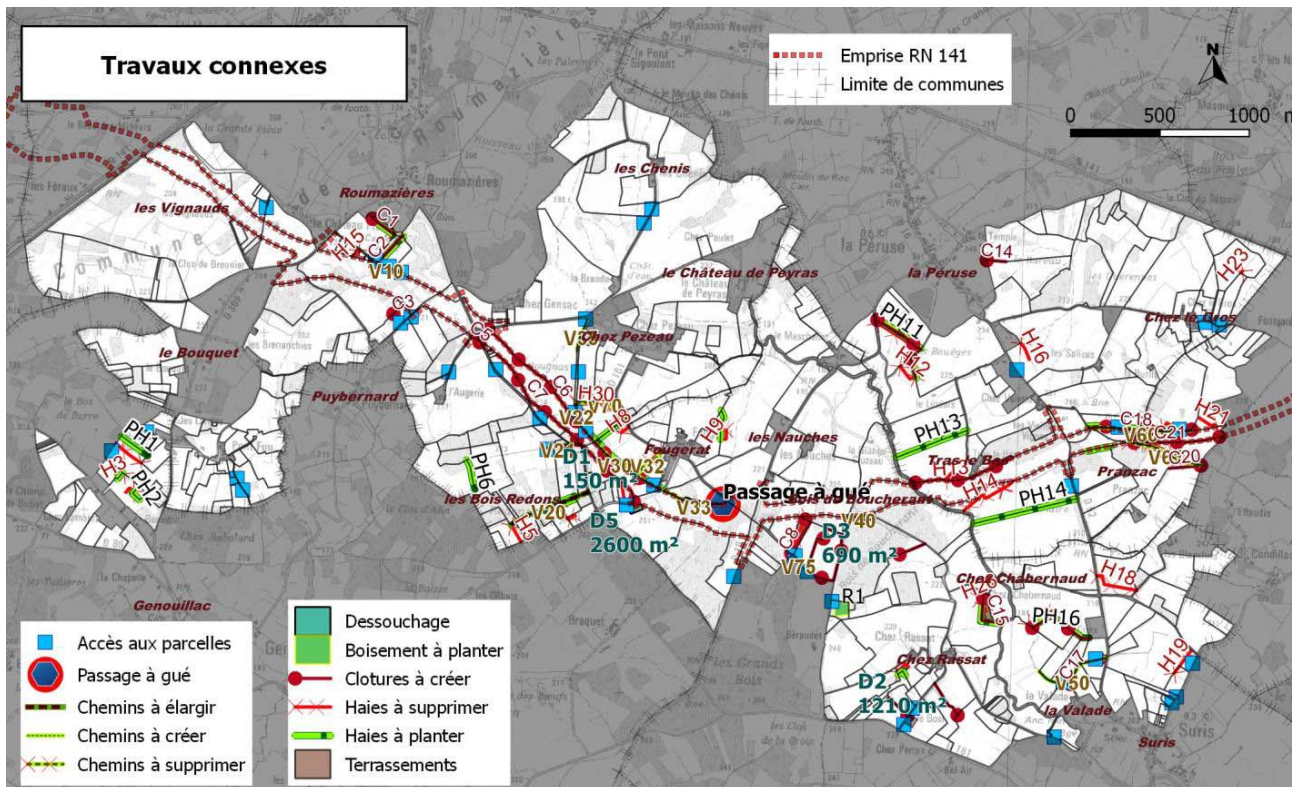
plan des travaux connexes et futur parcellaire (source : étude d'impact)
